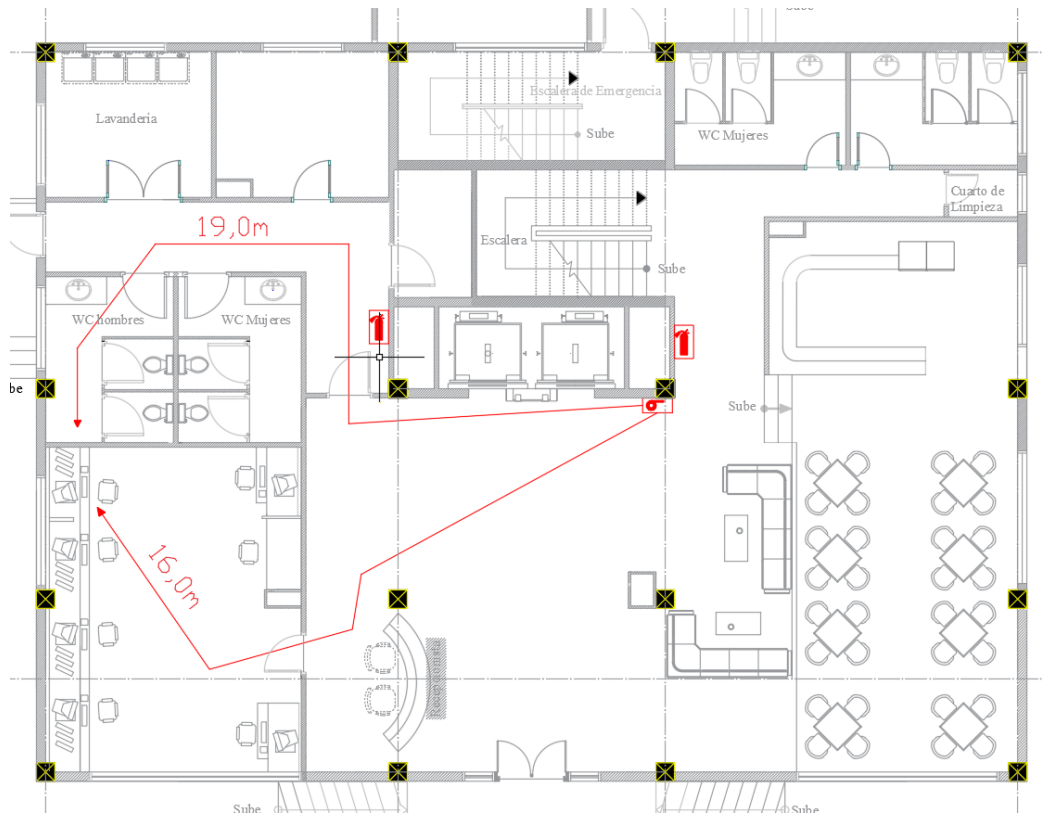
Radios de acción desfavorables BIEs planta baja.
